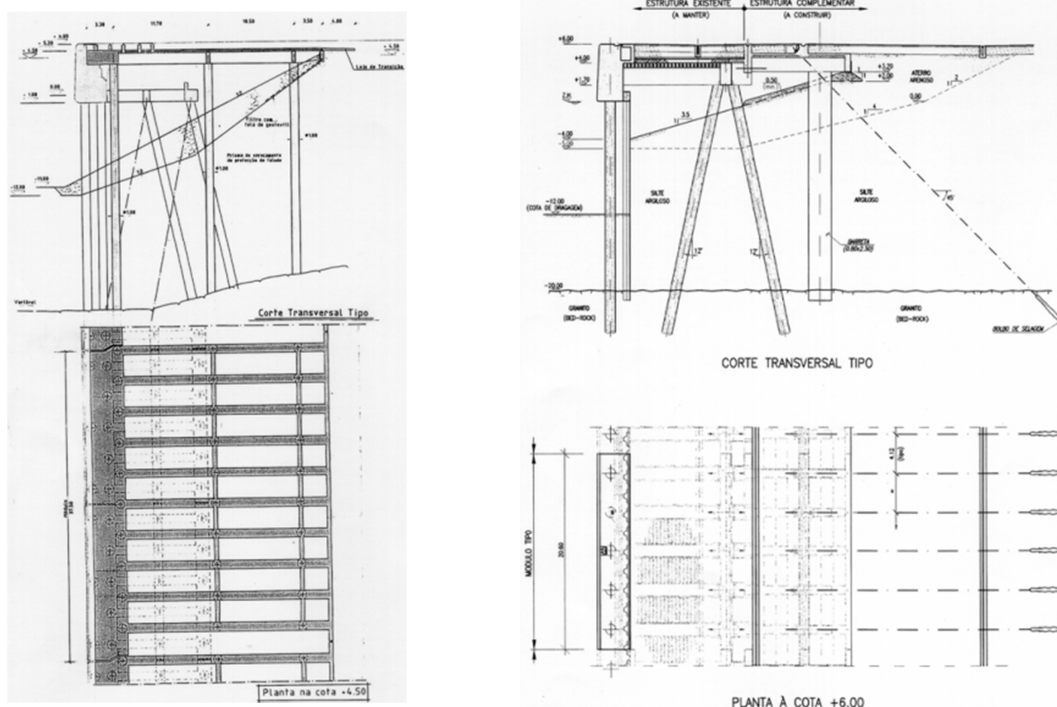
Obras de Reabilitação Tipo (Cais Norte da Doca 2 e Cais Sul da Doca 4)
